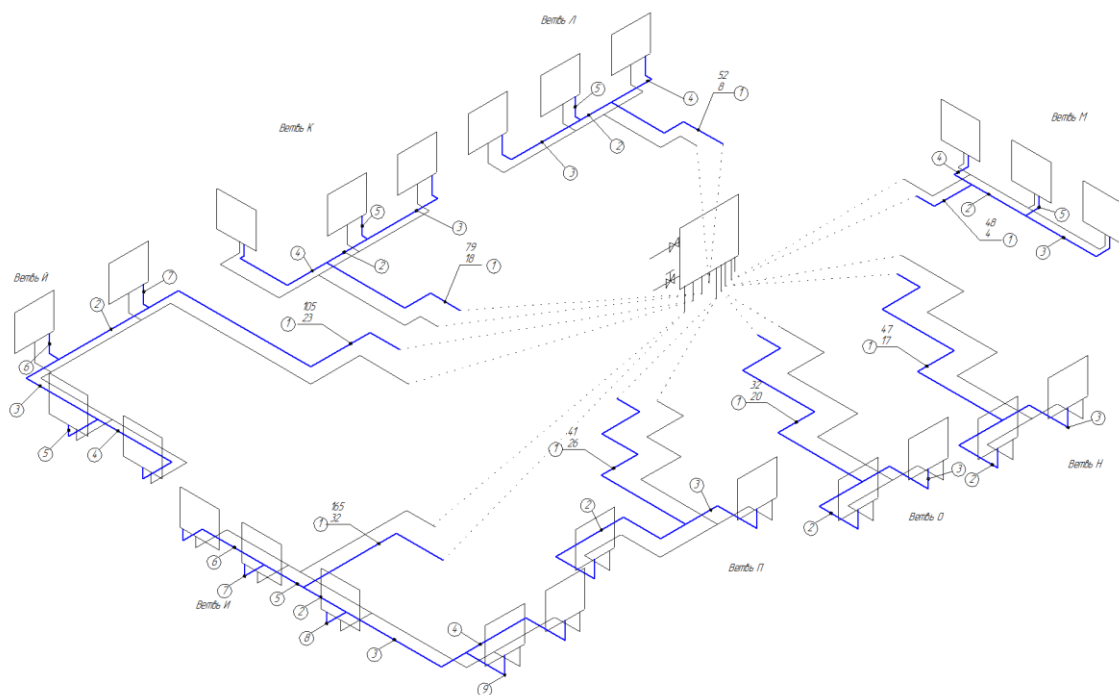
Расчетная схема отопления 2-го этажа
